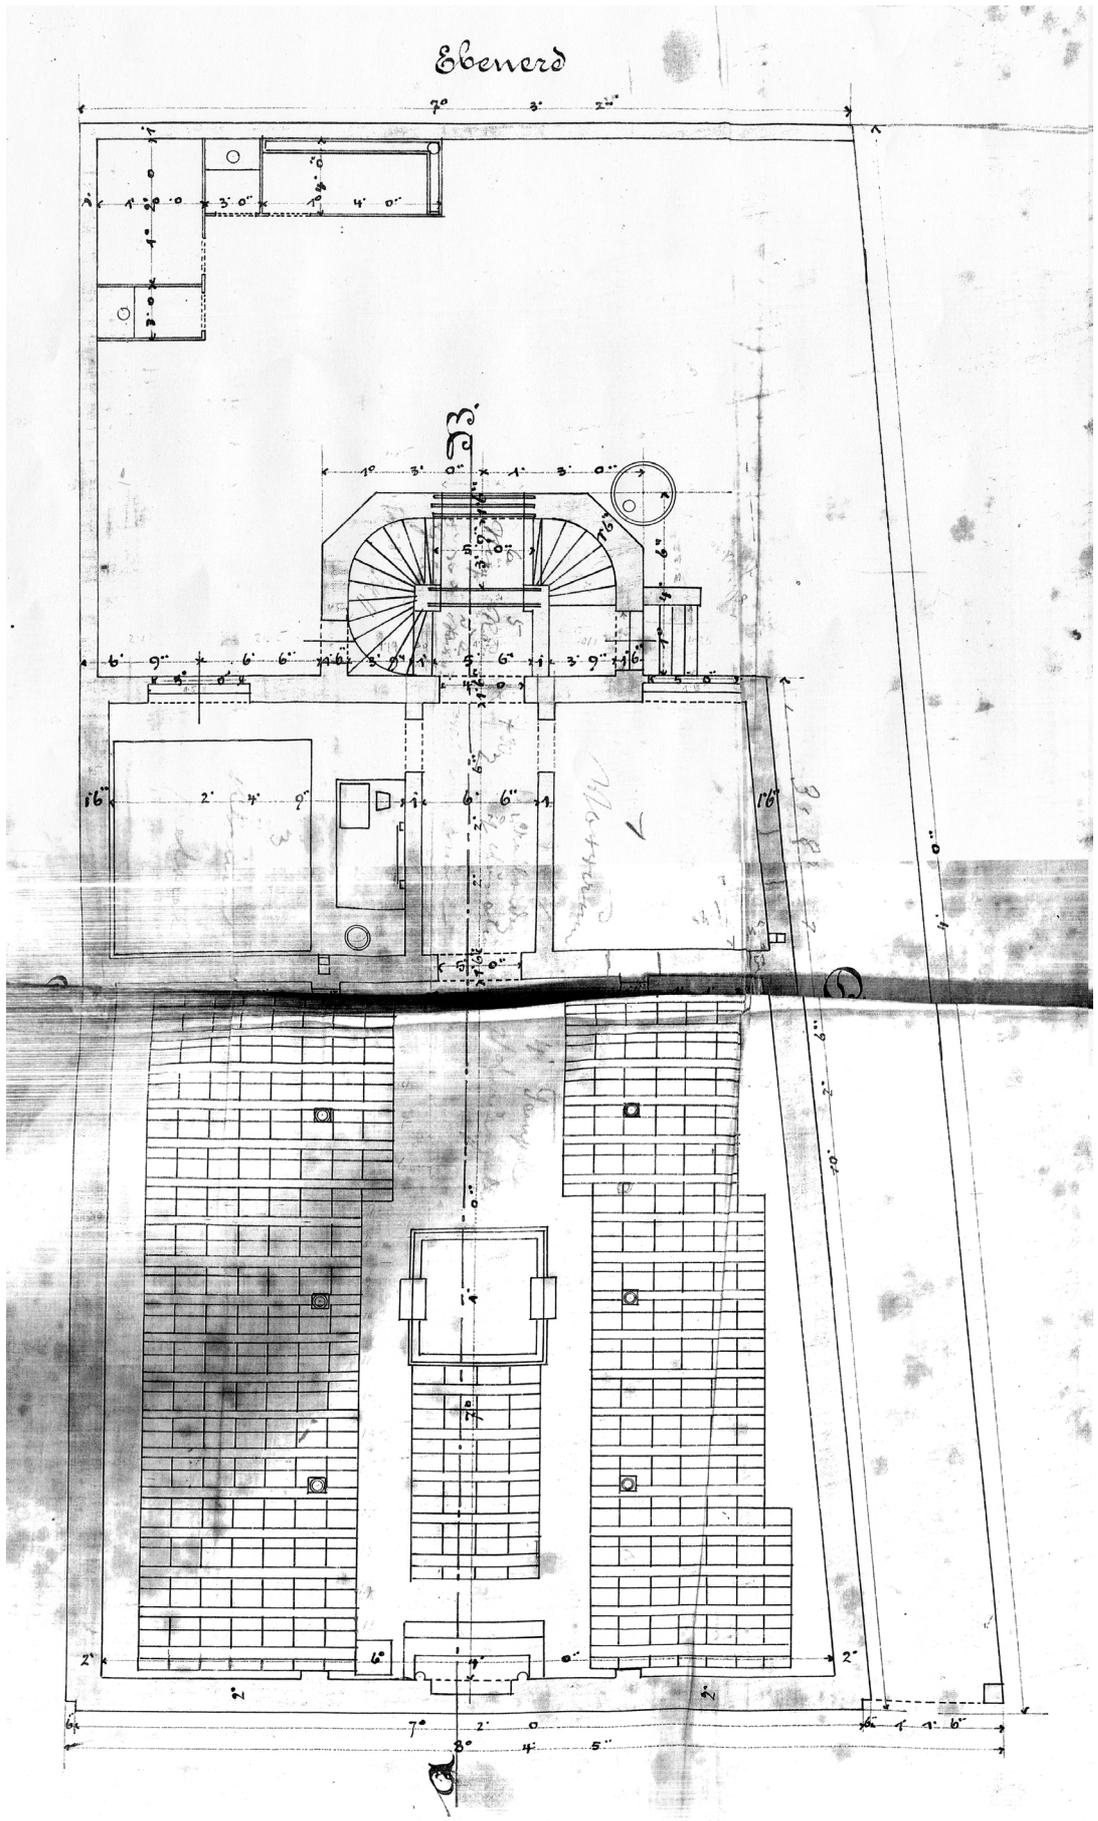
Grundriss des Erdgeschoßes, Jüdisches Museum Wien
